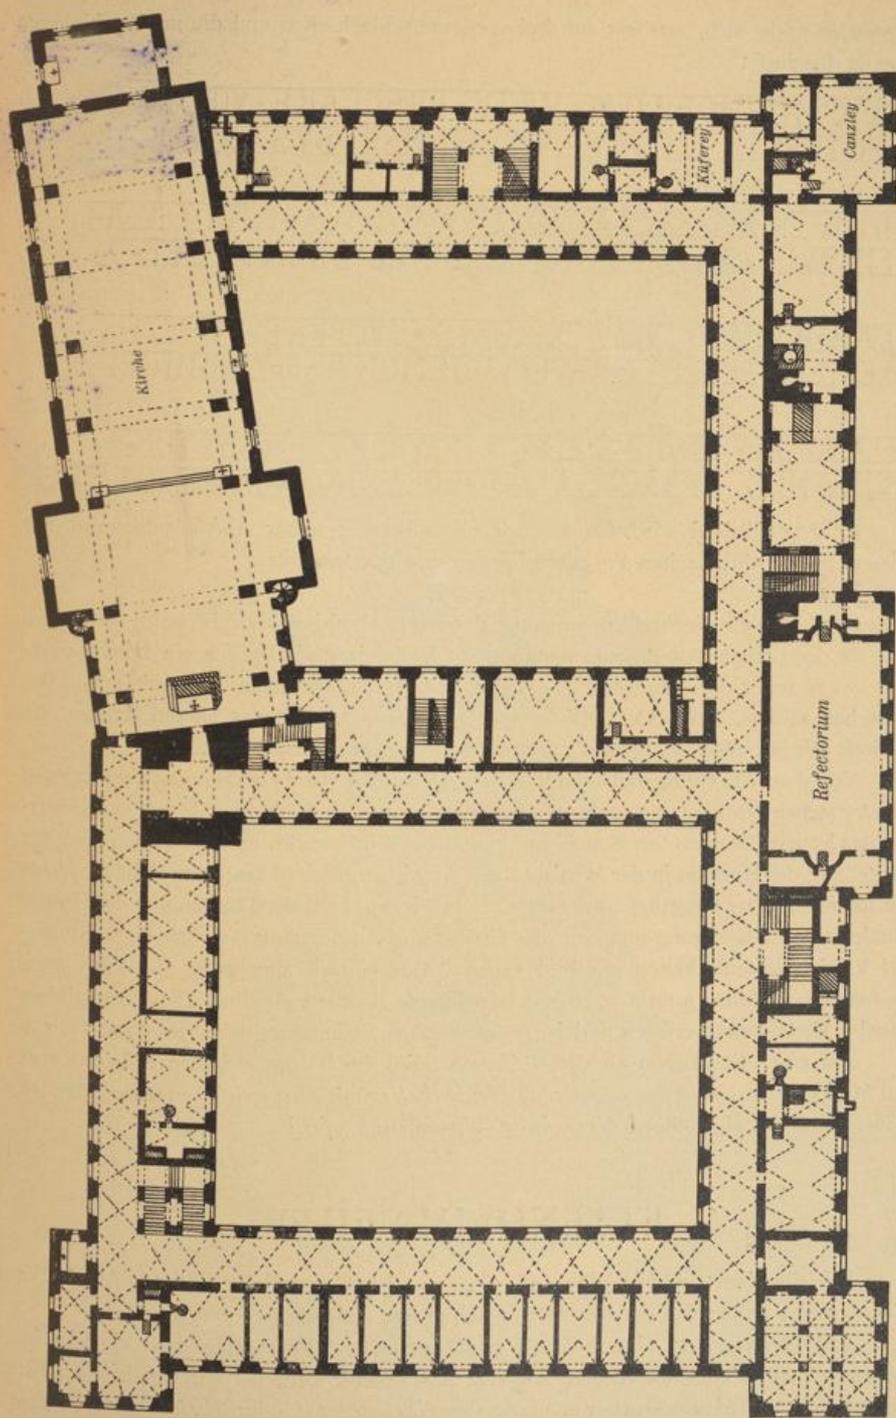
Ettenheimmünster. Grundriss des ehemaligen Klosters. Erdgeschoss.
